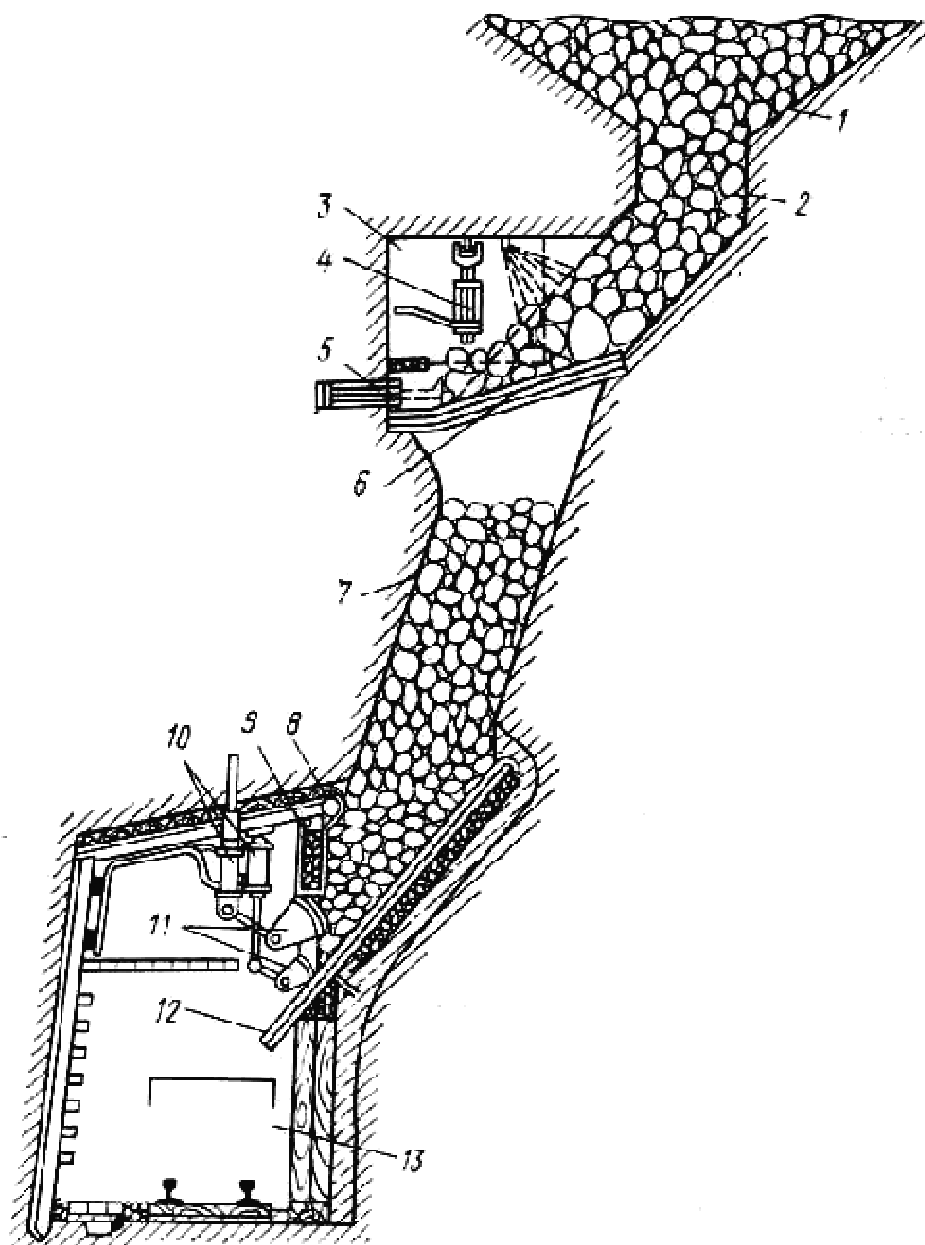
Участковый рудопуск с люком, оборудованным двухсекторным затвором: 1 — воронка; 2 — дучка; 3 — орт грохочения; 4, 5 — пневматические бутобои; 6 — грохот; 7 — рудопуск; 8 — отбойник; 9 — лобовина; 10 — пневмоцилиндры; 11 — двухсекторный затвор; 12 — днище; 13 — откаточный горизонт
